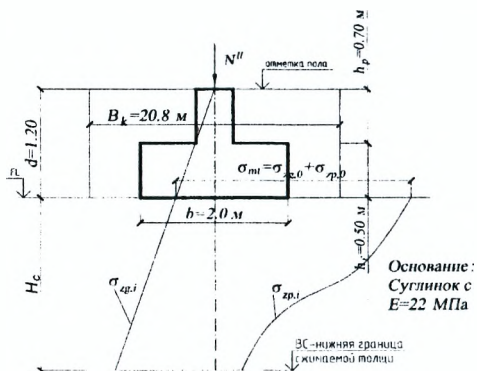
Расчётная схема для определения осадки столбчатого фундамента методом послойного суммирования
